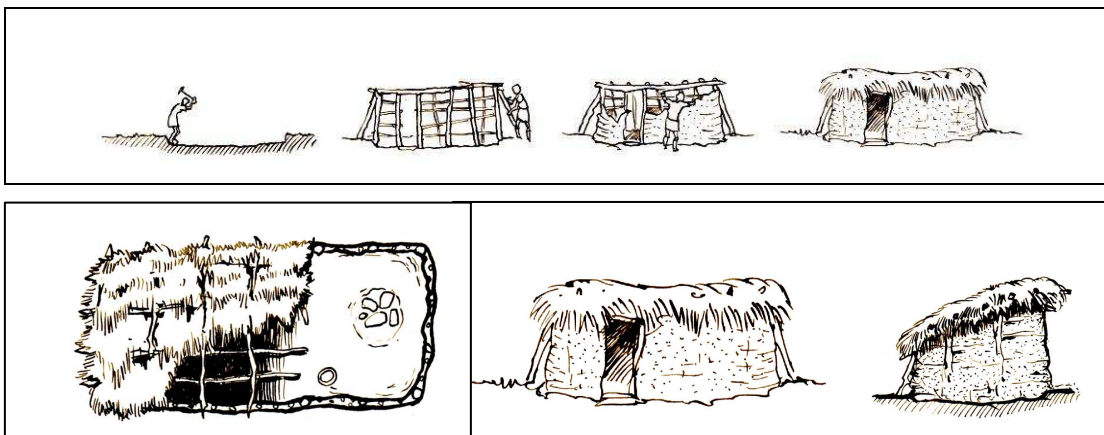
Secuencia constructiva de la cabaña de Los Torojones. Planta y alzados de la misma.
